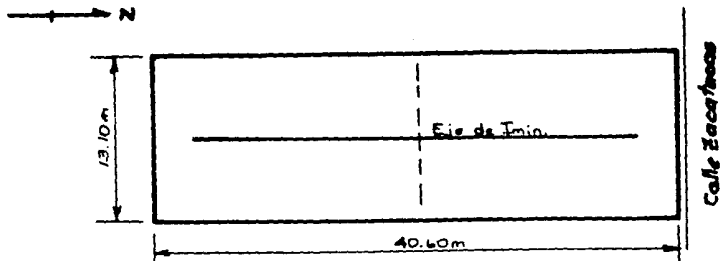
a Planta del edificio Zacatecas 74. Esc. 1:400.
